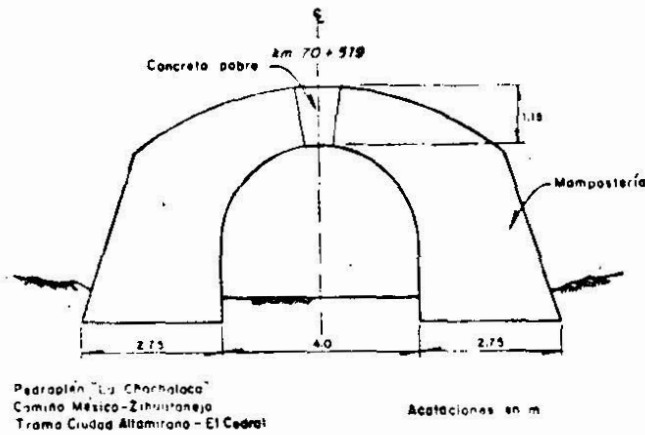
Sección transversal de la alcantarilla del pedraplén "La Chachalaca".
